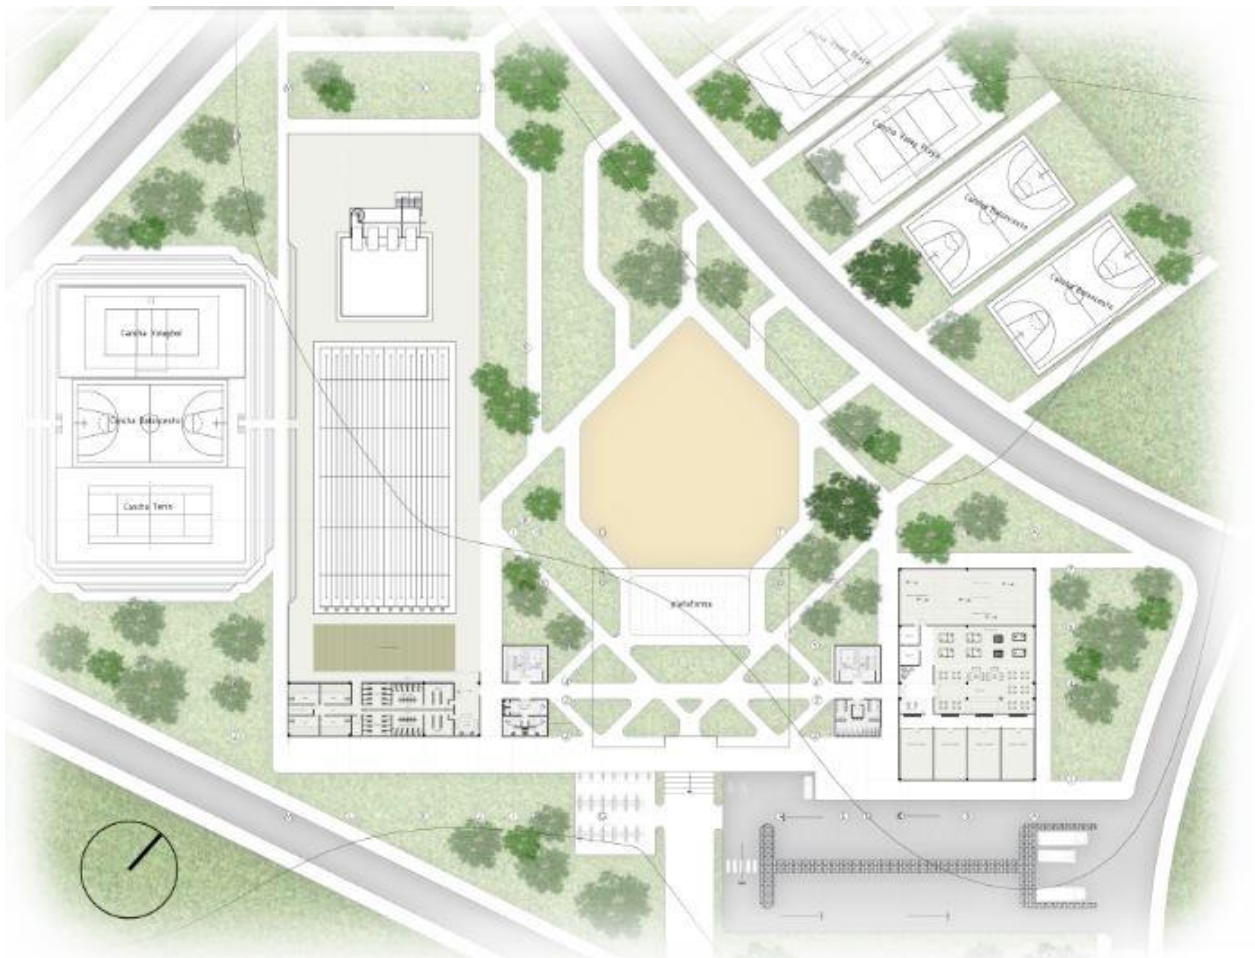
Planta 1er nivel / Autoría propia (2017)
